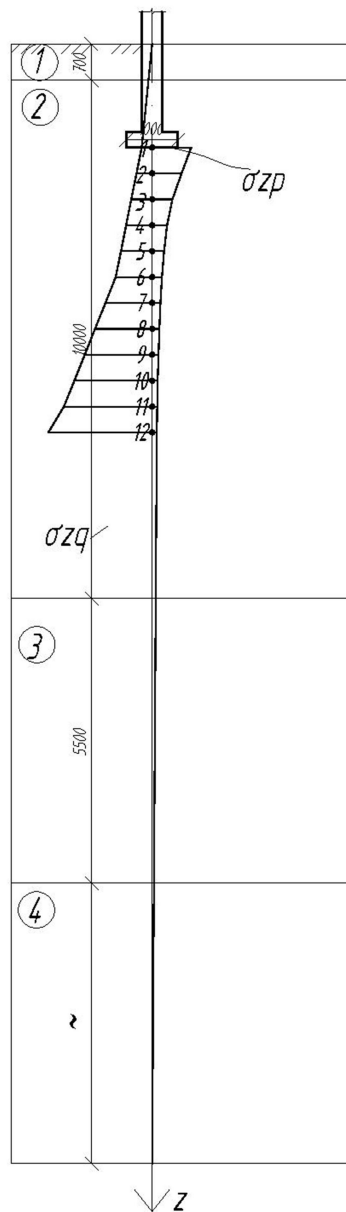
Определения осадки фундамента мелкого заложения под стену.
